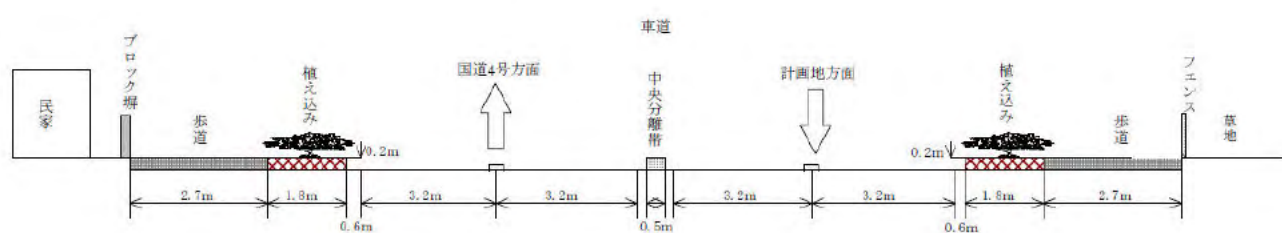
騒音予測地点a近傍の詳細図及び道路断面図
